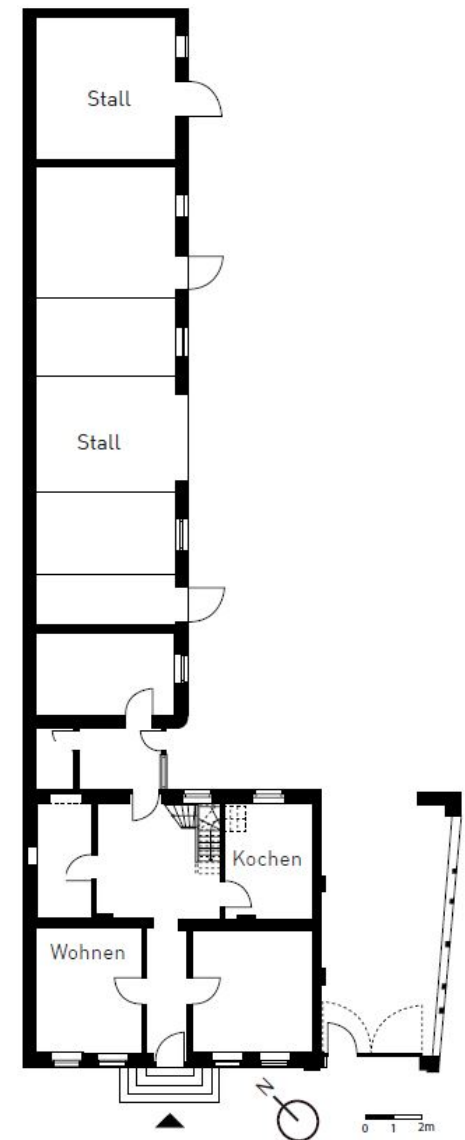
Erdgeschoss Grundriss, 2021.
